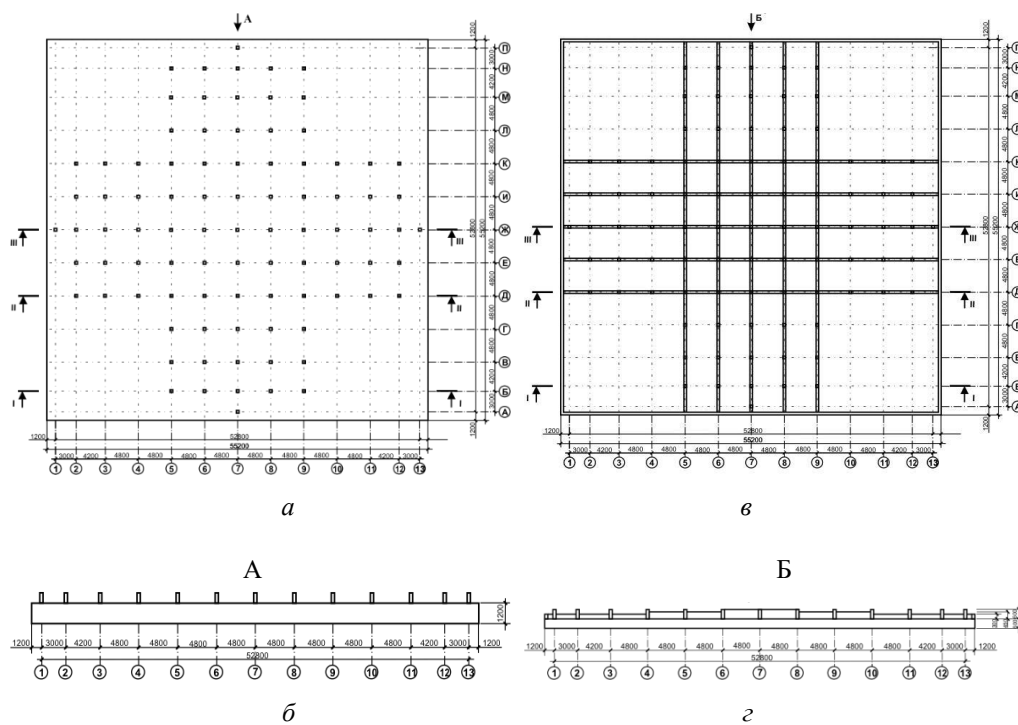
I варіант – план фундаменту (а) та вид А (б),
